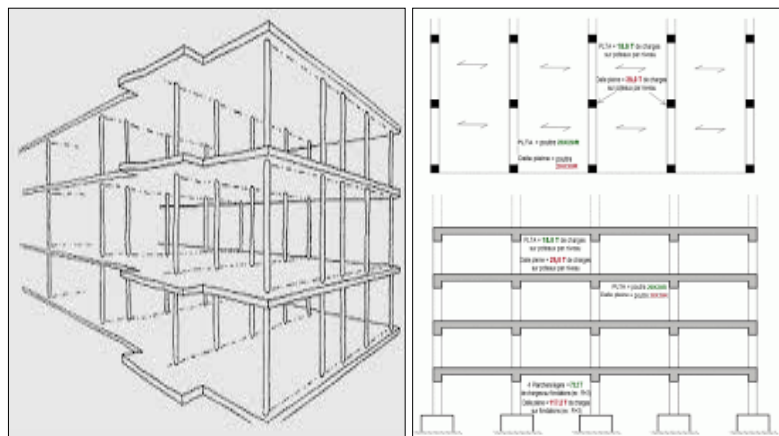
plan +coupe d'un system de structure pourtique SOURCE : <http://docs.autodesk.com>
